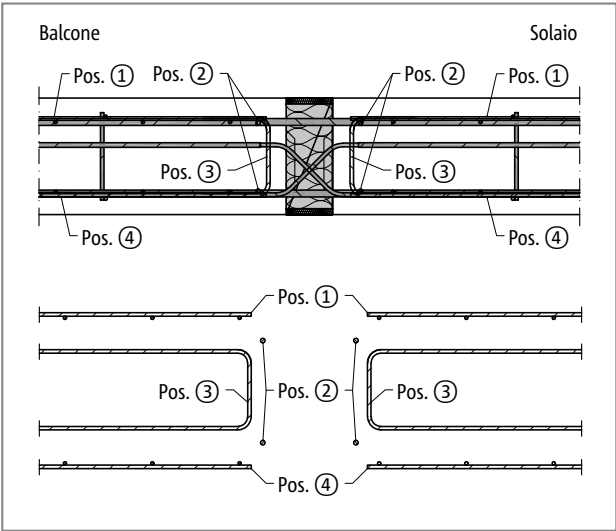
Schöck Isokorb® T tipo DL: armatura in opera
